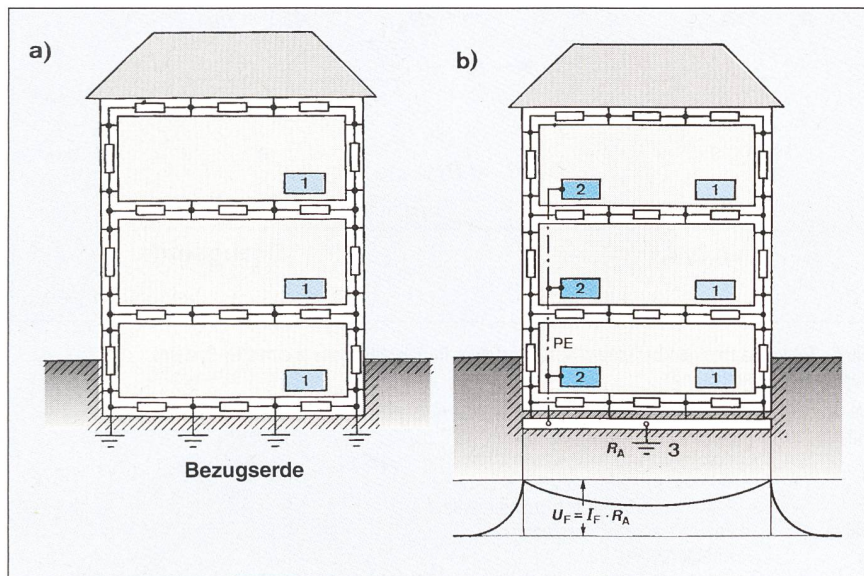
Prinzipielle Darstellung des elektrischen Schemas von Gebäuden aus schlecht leitenden Baustoffen mit Rohrsystemen aus Isolierstoff
